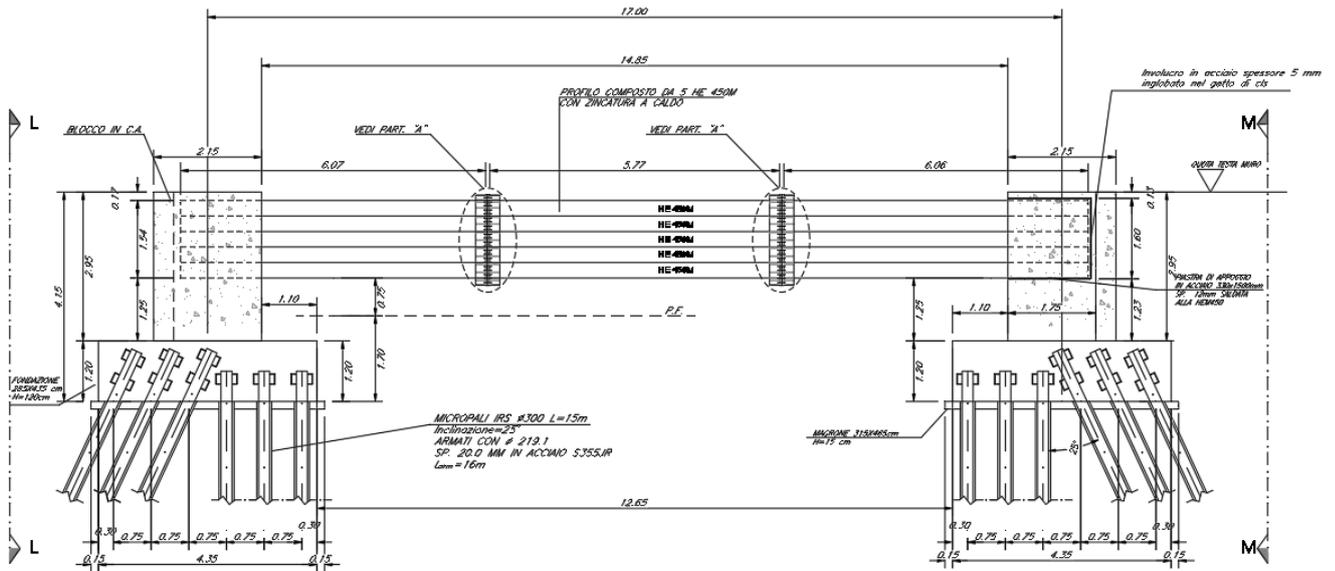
MU03 - prospetto generale muro opera di protezione con luce asse-asse di 17.00 m
